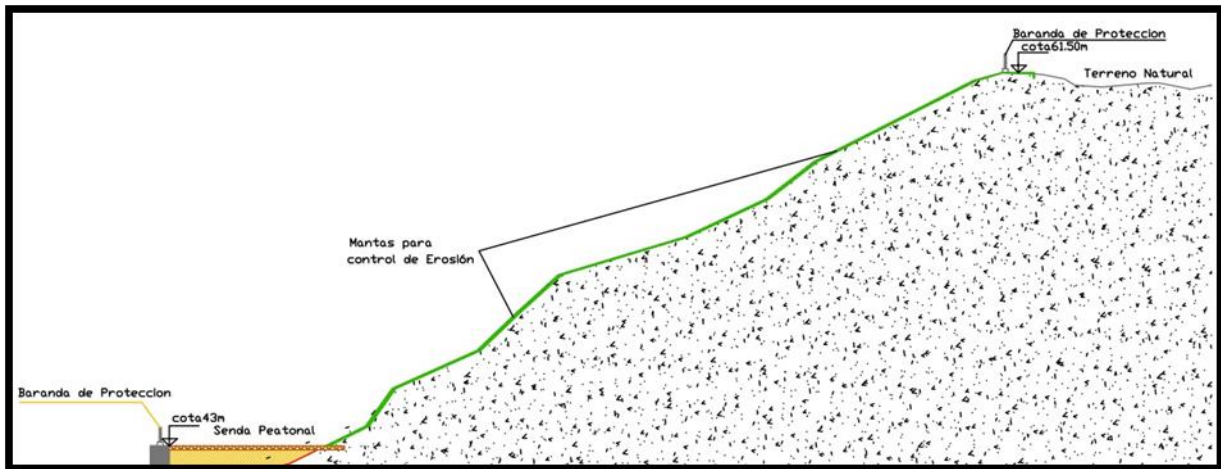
Esquema sección transversal con ubicación de geomanta (fuente: elaboración propia).
